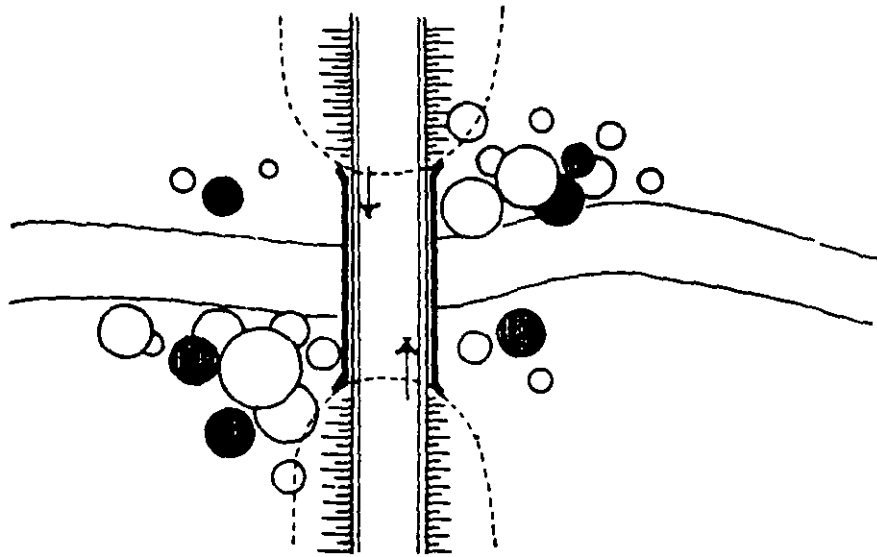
CRITERIO DE ZONIFICACION DE PLANTACIONES EN TANGENTE
